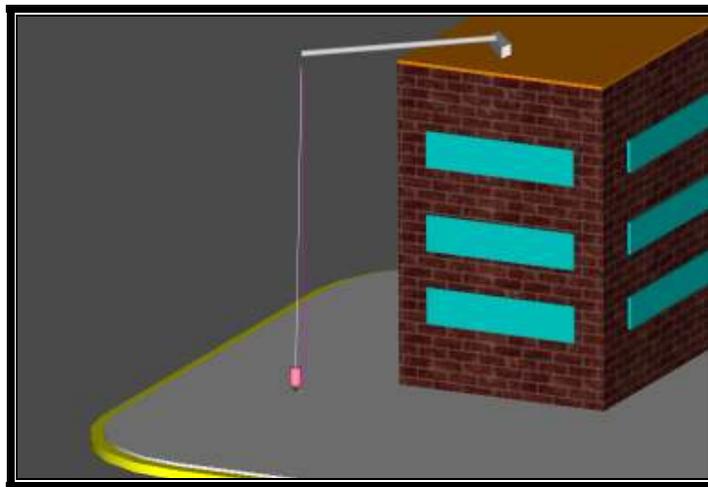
Plomada, Muerto de Concreto y Tubo de amarre del Edificio. Vista 3d.
